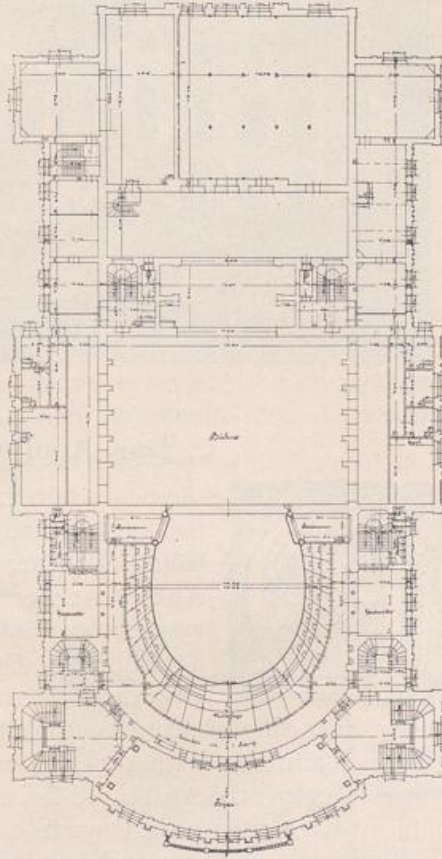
Grundriss des 1. Rangs. 1:740.
